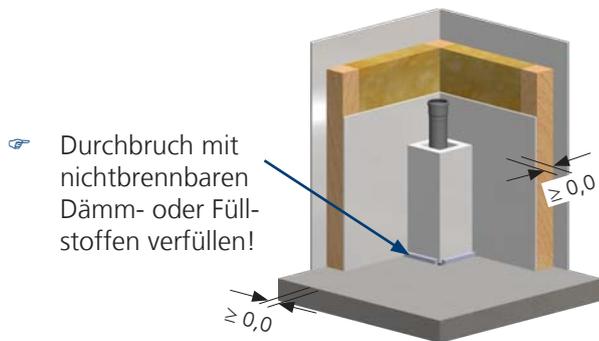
Brandsicherheitsabstand zu brennbaren Baustoffen
